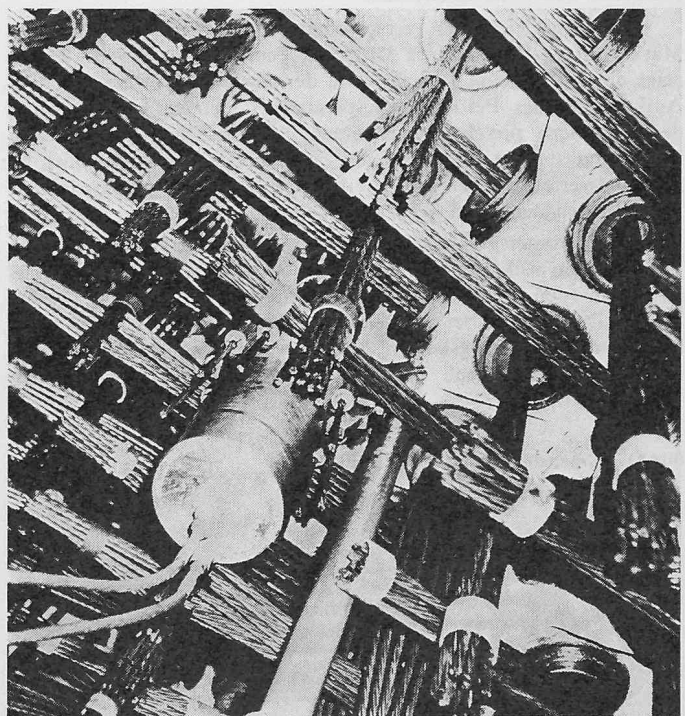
Stahl-Spannkabel in einem Druckgefäss für einen gasgekühlten Reaktor
